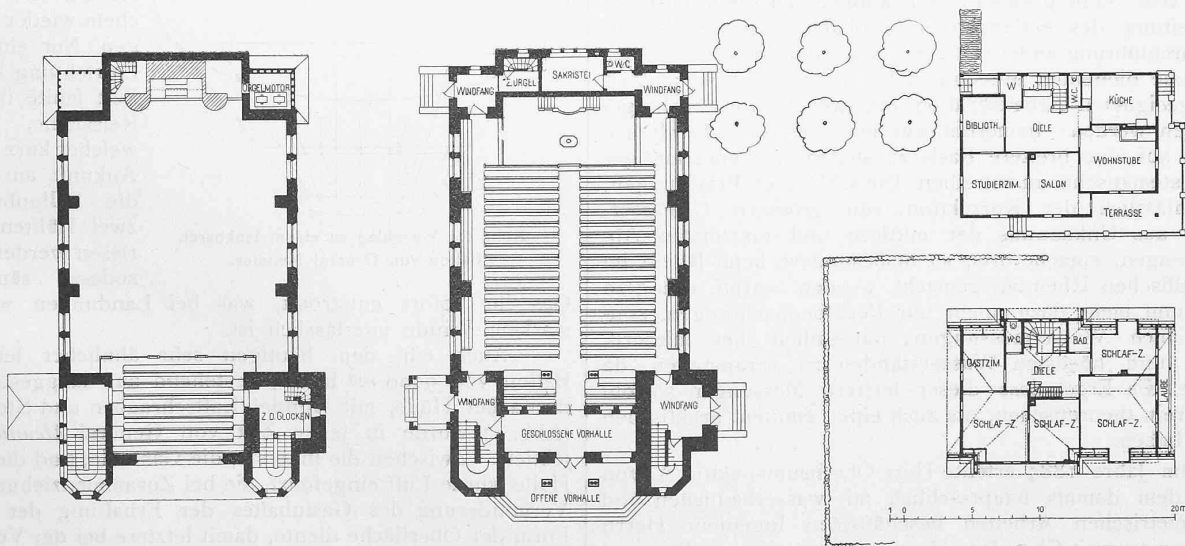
bis 6. Grundrisse von der Kirche sowie vom Erdgeschoss und ersten Obergeschoss des Pfarrhauses. — Masstab 1:500.
